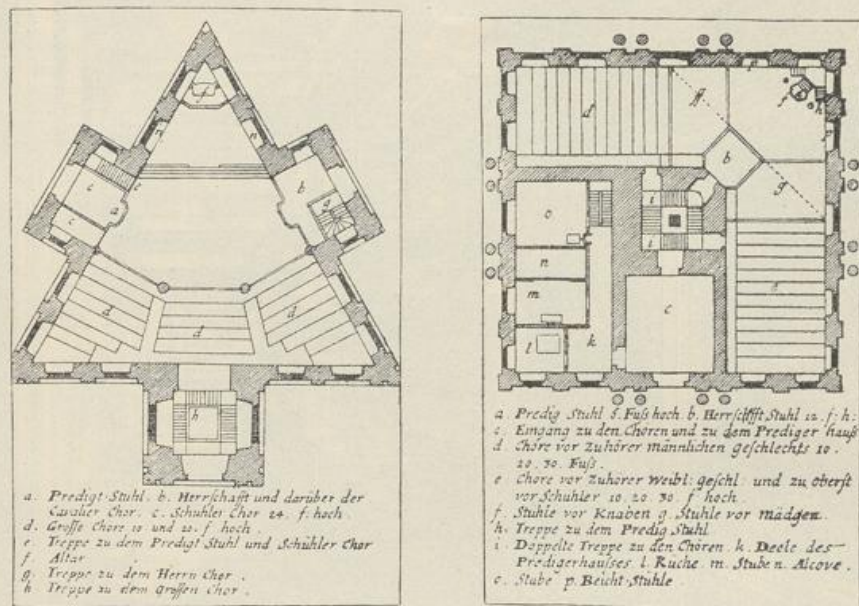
und 119 Grundrisse für protestantische Kirchen von C. L. Sturm
